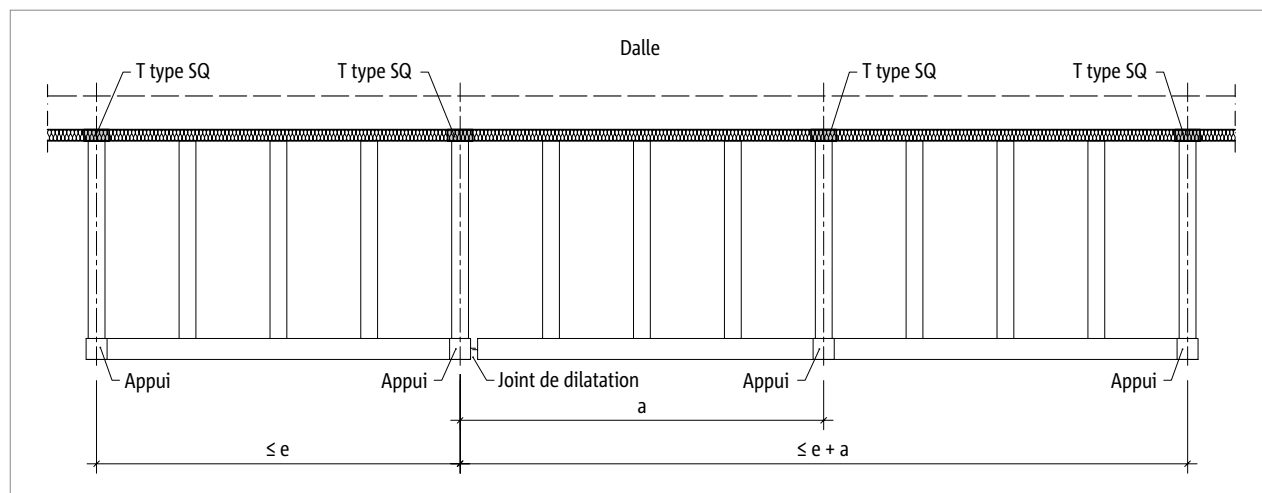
Schöck Isokorb® T type SQ : distance maximale entre joints de dilatation e et débord latéral a
